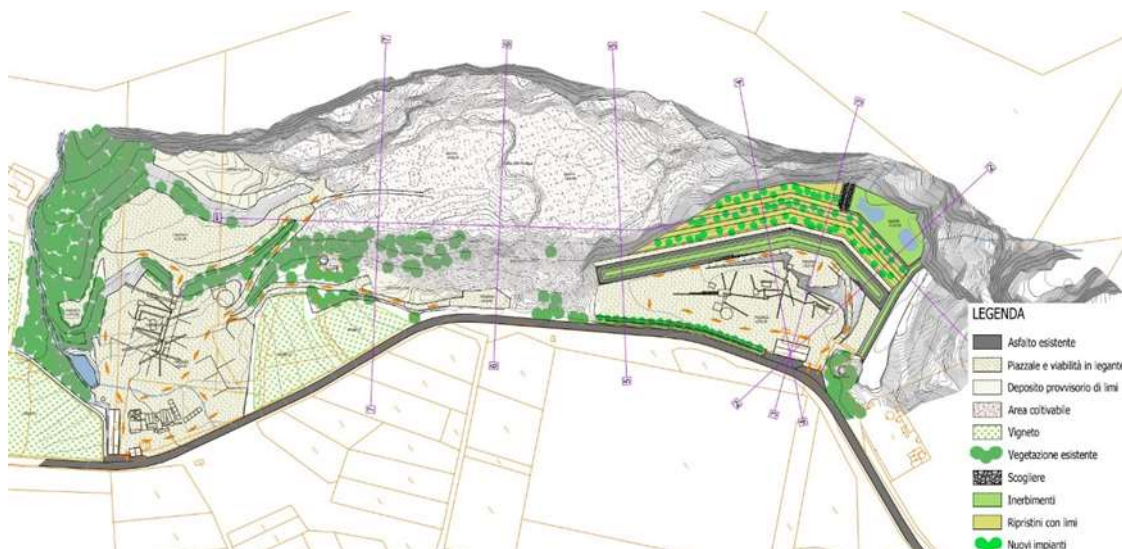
Planimetria fase 2B con mascheramenti provvisori
